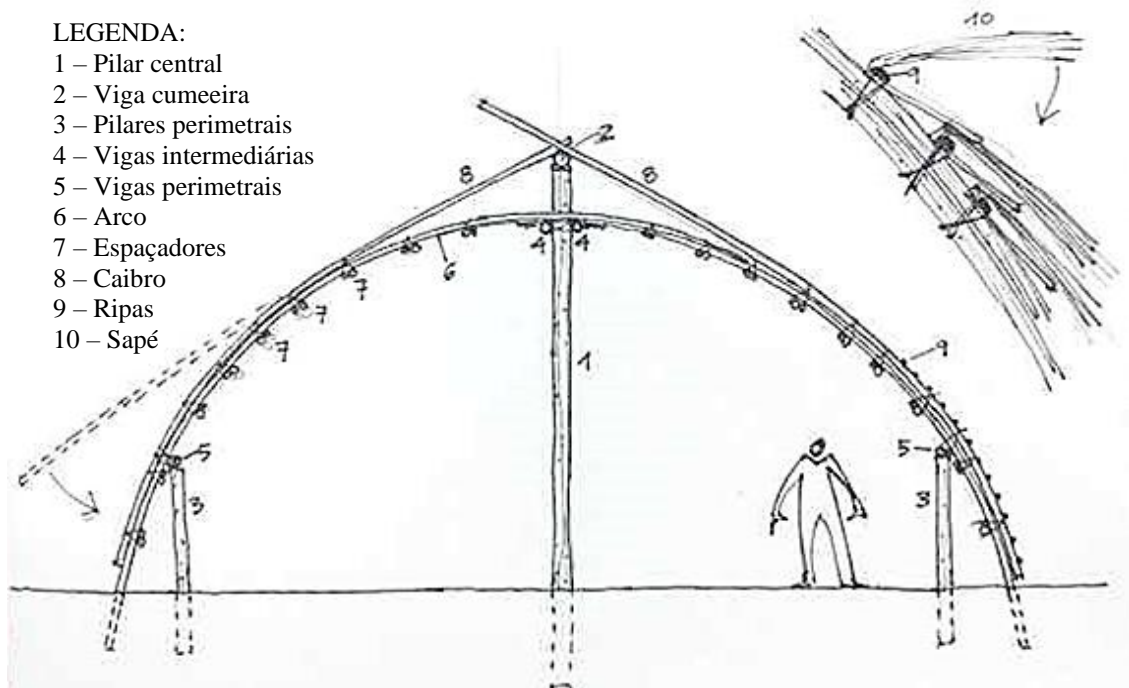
Viga de feixes de madeira apoiada sobre os pilares periferais
